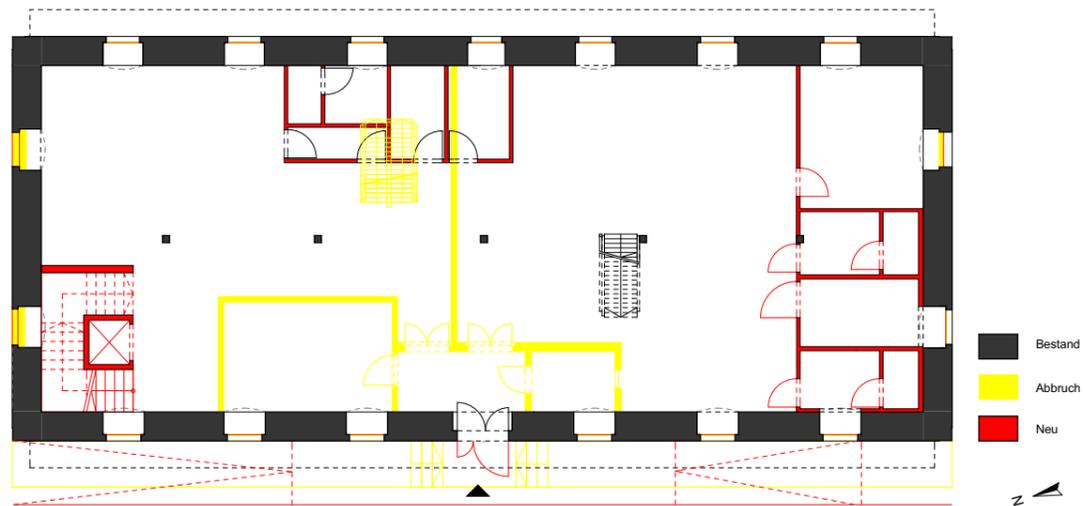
Bauliche Maßnahmen im Erdgeschoss des Kornhauses
